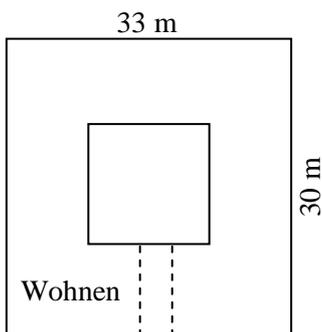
Grundrisskizze des Vierkanters
